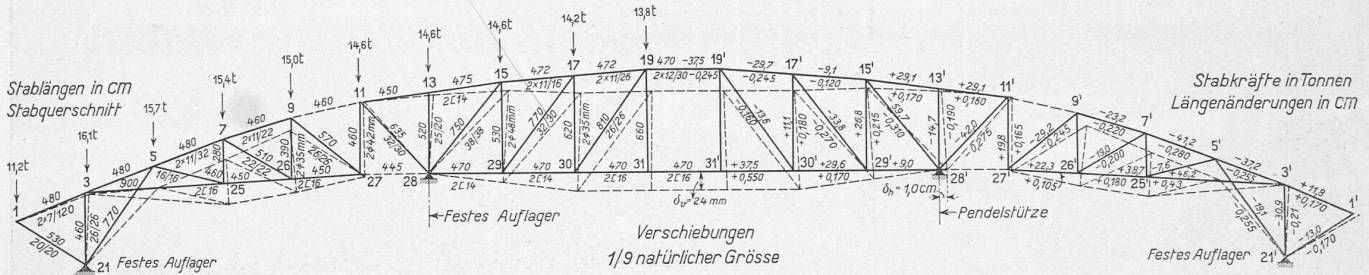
Schema des Lehrgerüsts, System Klinke & Meyer, mit Eintragung der rechnermässigen Spannungen und Verformung (verzerrt) durch die volle Betonlast.
